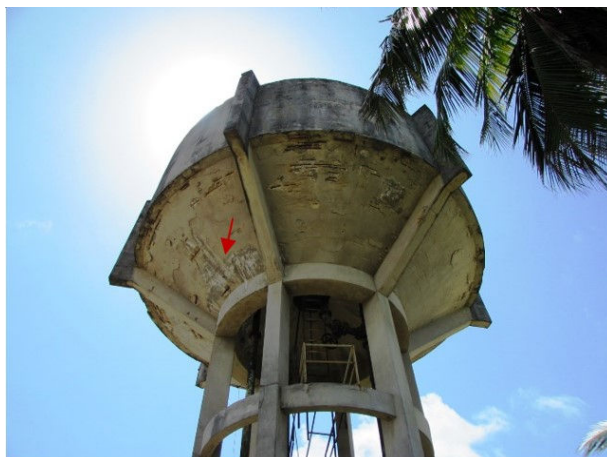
Vista geral do fundo cuba do reservatório com zonas de corrosão da armadura e deslocamento do concreto, em destaque incidência de eflorescência
